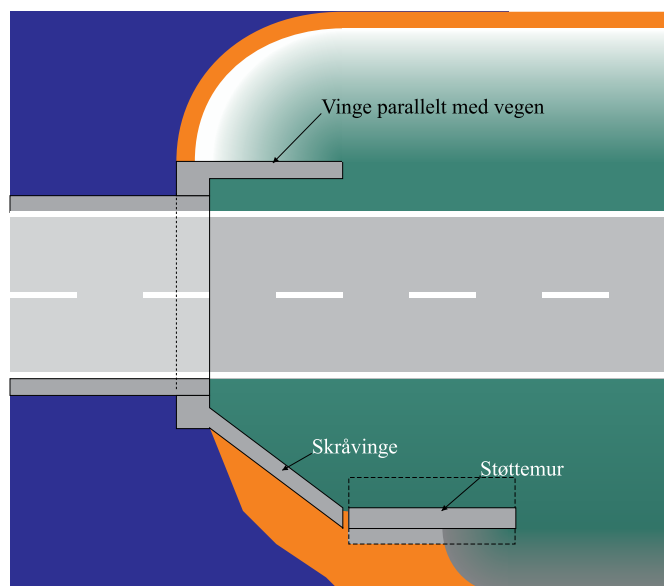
Element G Støttekonstruksjon, støttemur i tilknytning til Landkar
